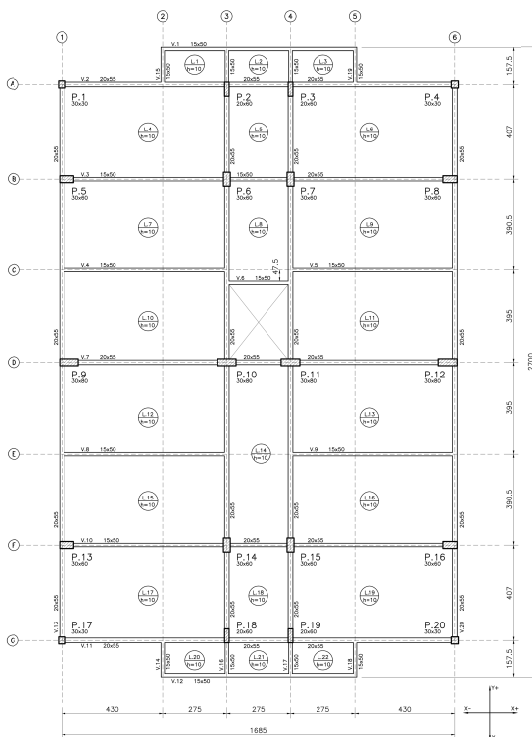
Forma do pavimento tipo da Estrutura 3.
